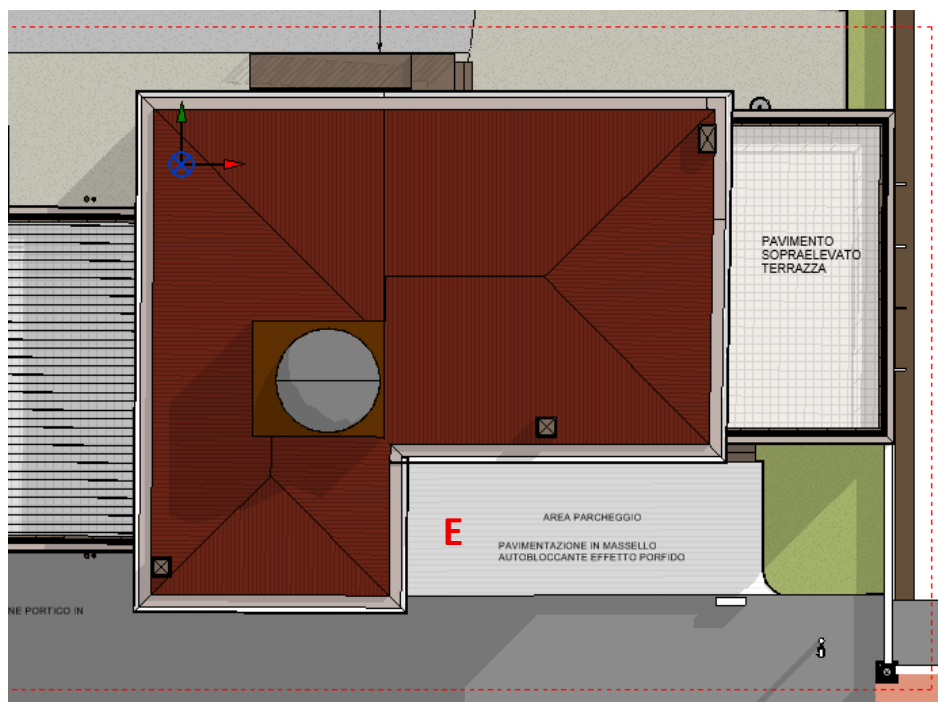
EDIFICIO B - Stato di progetto parcheggio esterno.
